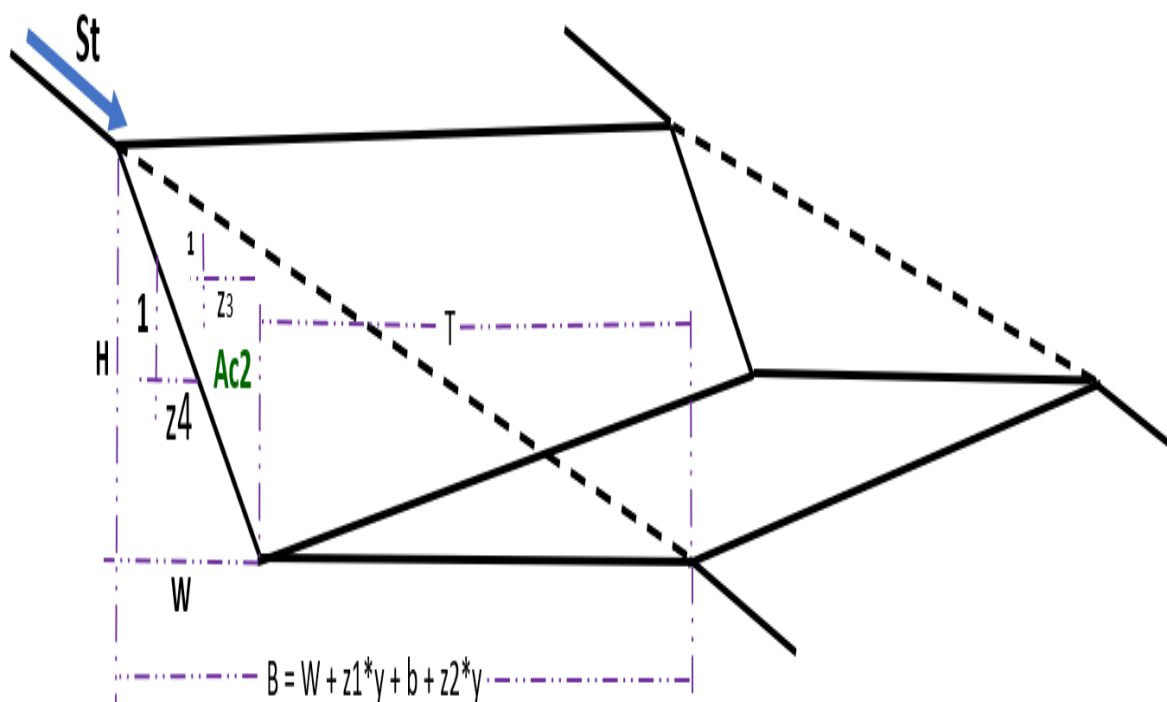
Área de corte 2 “Ac2” para una acequia de ladera trapezoidal
